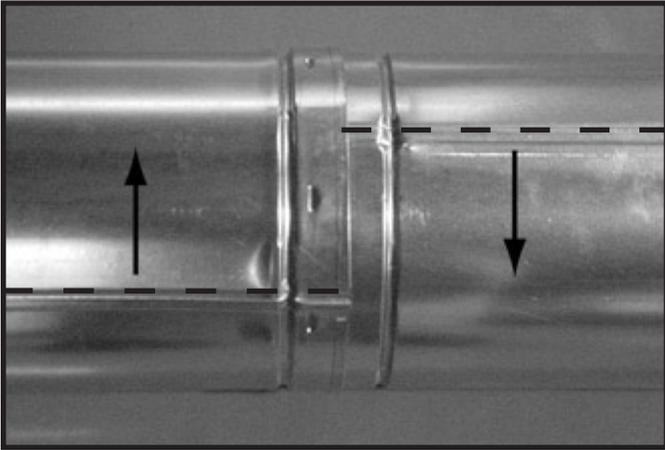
Faire pivoter les joints d'assemblage pour démonter
